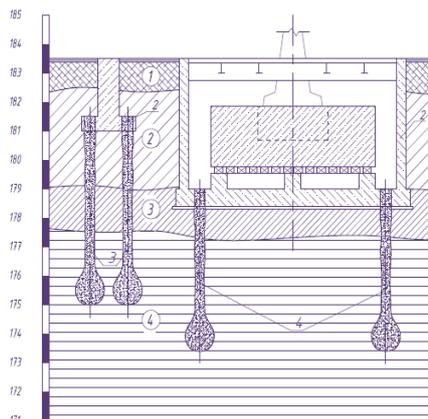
Инженерно-геологический разрез с вертикальной привязкой заглубленных железобетонных конструкций: 1 – фундамент каркаса здания; 2 – фундамент кузнечного молота; 3 – буроналивные сваи – ЭРТ усиления оснований фундаментов каркаса; 4 – буроналивные сваи – ЭРТ усиления оснований фундаментов кузнечных молотов; «1» – насыпной слой; «2» – суглинистый тугопластичный; «3» – суглинок мягкопластичный; «4» – глина алевритистая тугопластичная.
